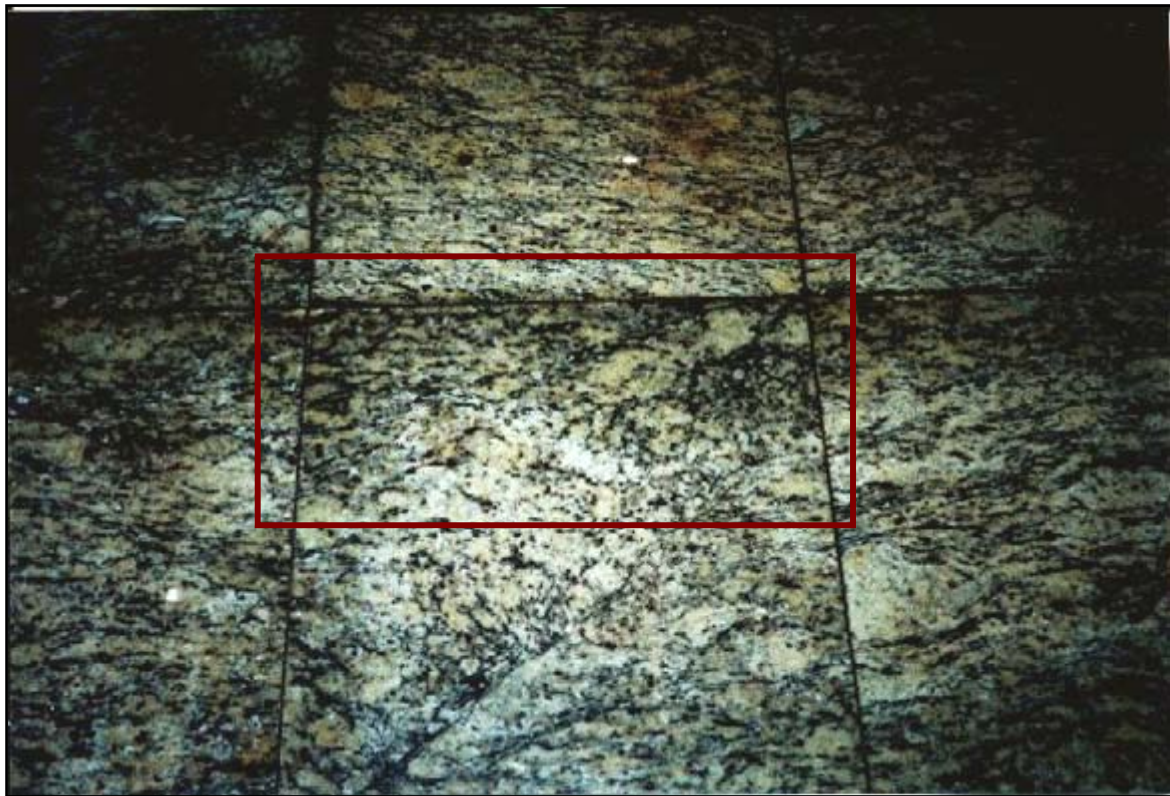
FOTO ILUSTRANDO SITUAÇÃO DE MANCHAMENTO EM PLACAS DE GRANITOS REVESTINDO PISO - RIO CLARO, SP
